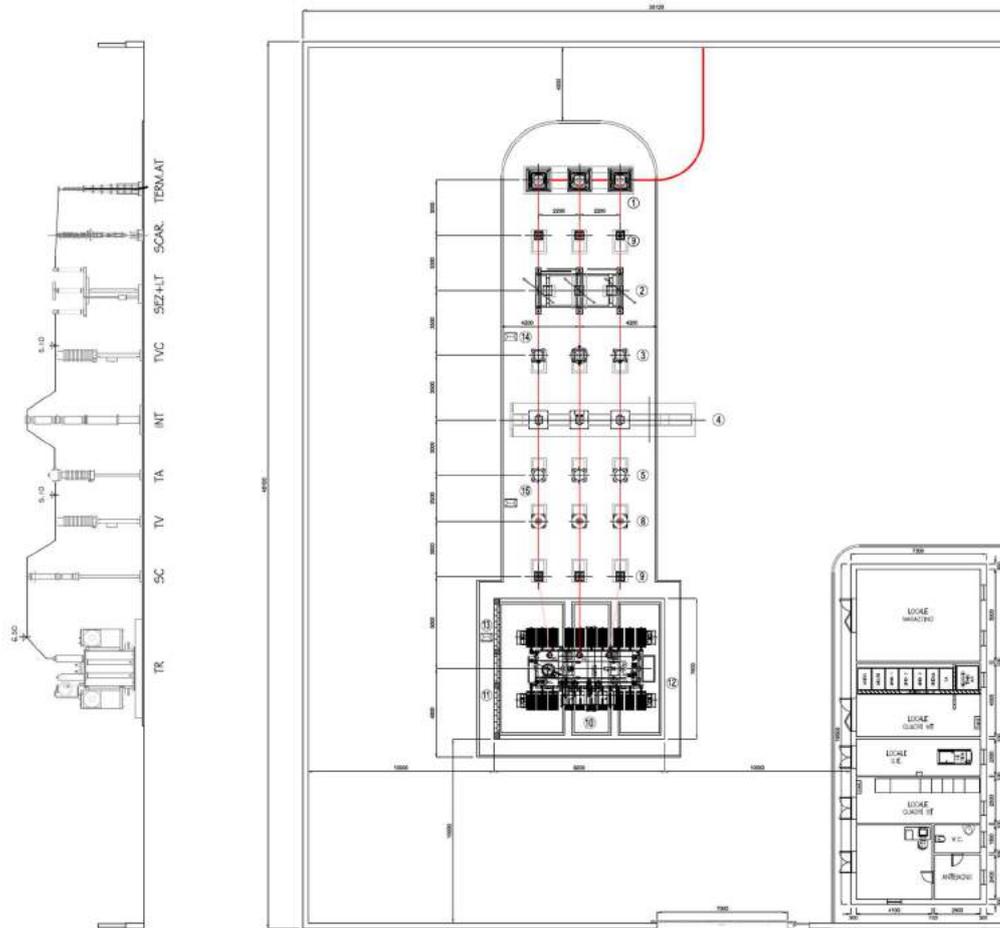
Planimetria e sezione elettromeccanica della SSE Utente
